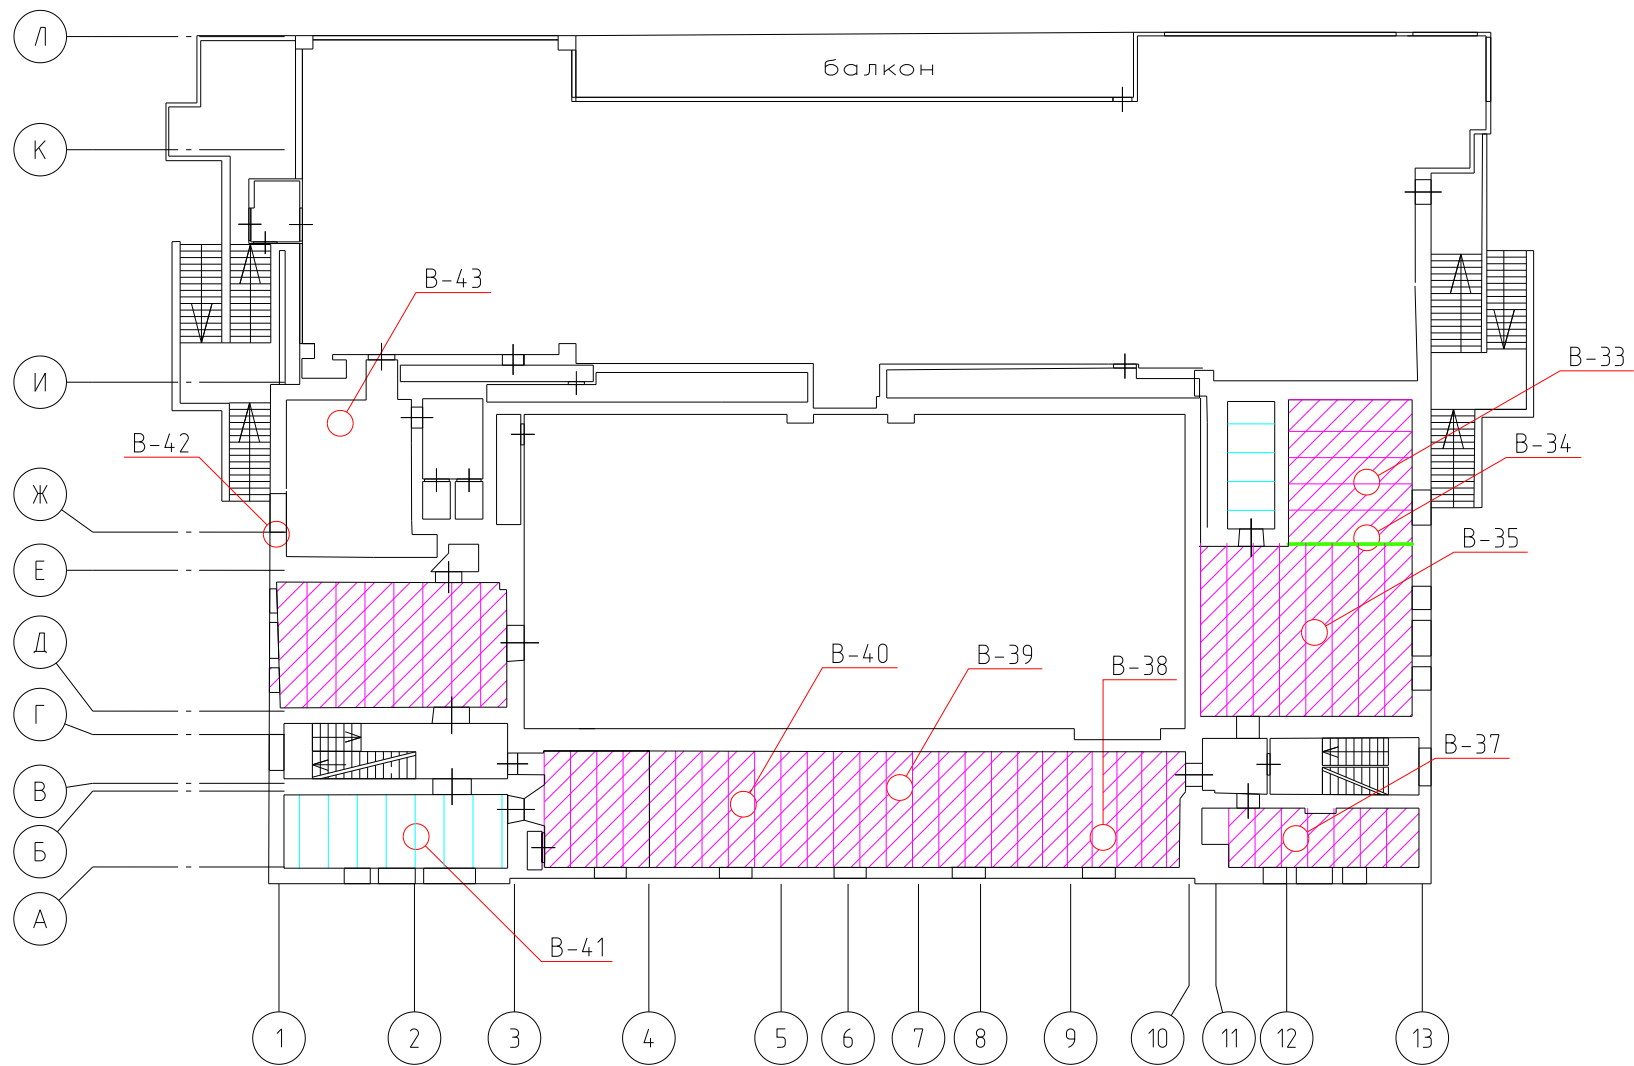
Схема участков вскрытий над вторым этажом с раскладкой плит и балок.
